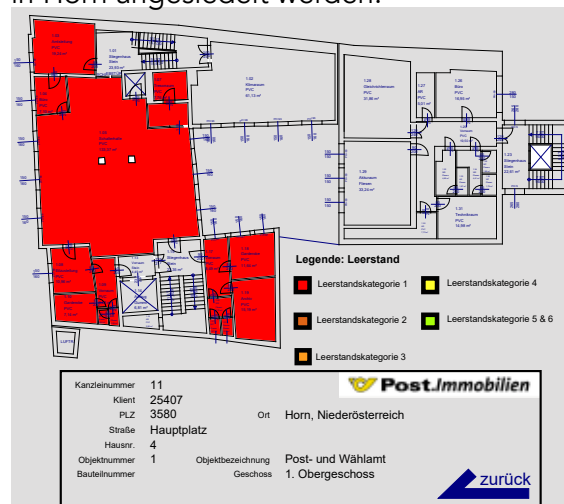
Grundrissplan des 1. OG, immmo.at
